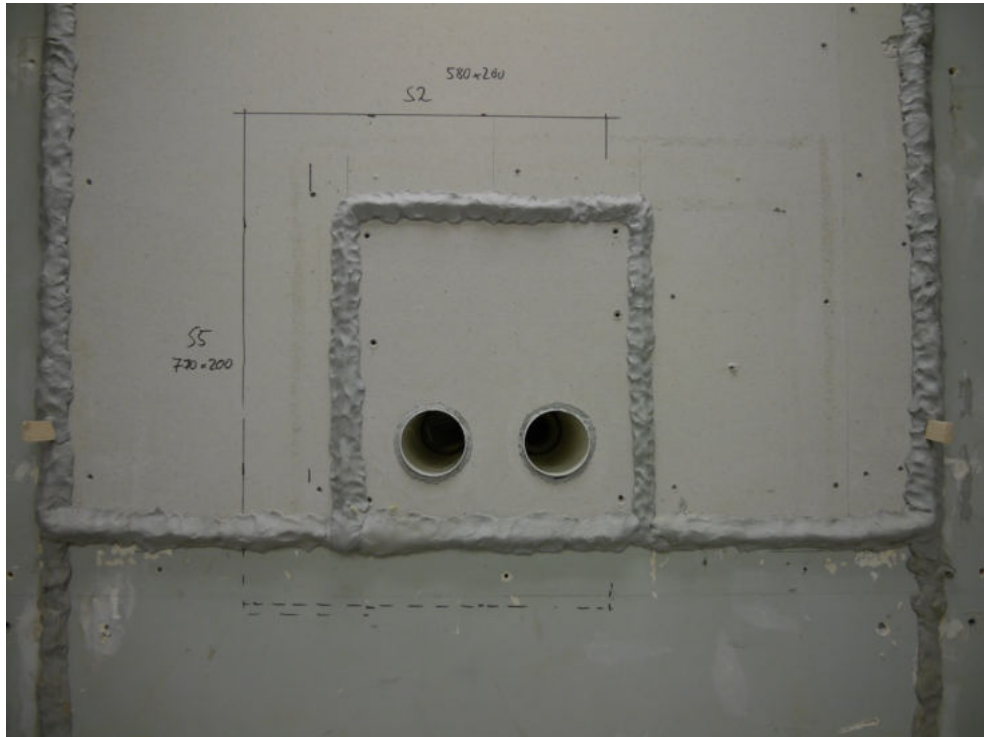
Lüftungsöffnungen außenseitig (Fortluft links, Außenluft rechts), Fassadenabschluss Edelstahlschote noch nicht montiert.
